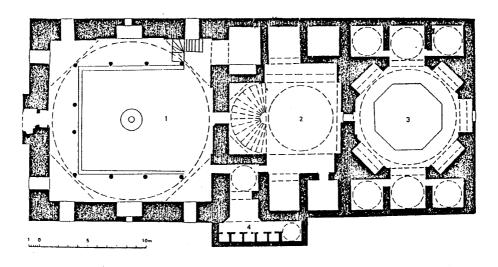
مسقط أفقى لچشمة قره مصطفى باشا في أدرنة (عن : ÖNGE) .
